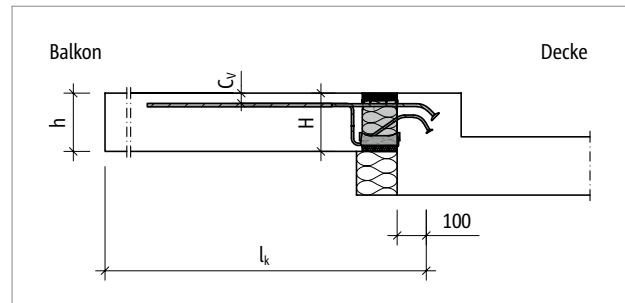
Schöck Isokorb® XT Typ KL-O: Statisches System
